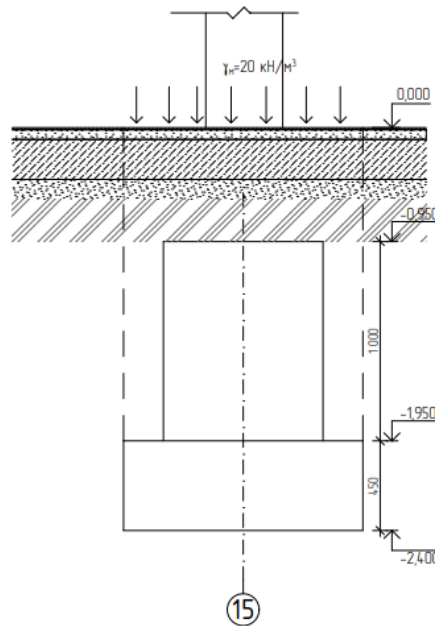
Обозначение объемного веса грунта, бетона и пола, действующего на основание фундамента
